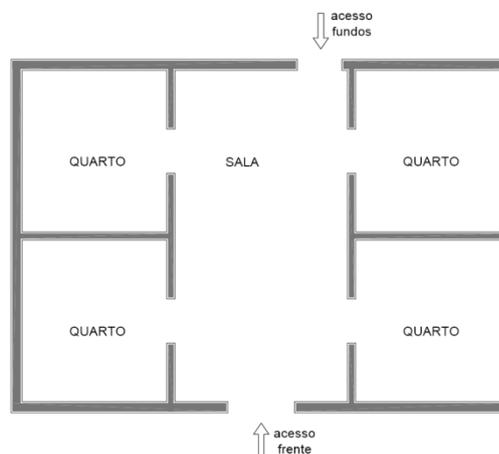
Planta baixa típica do imigrante alemão no Brasil.
